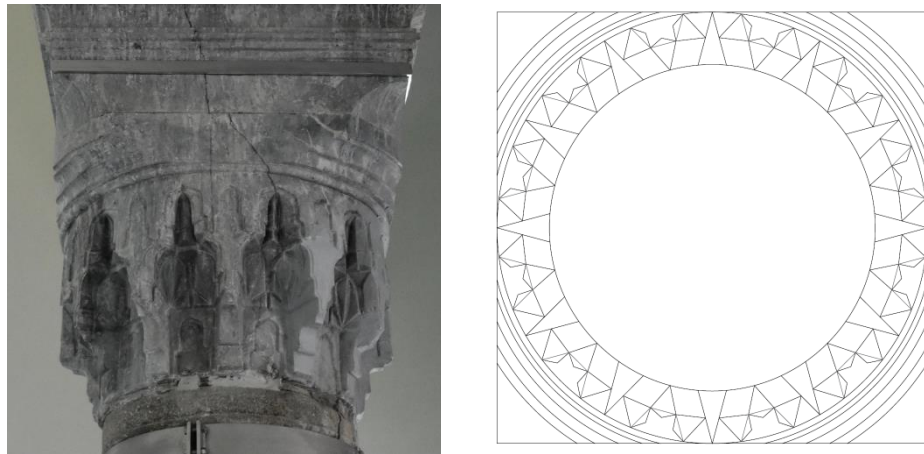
Edirne Eski Cami'nin Minare Sütuncesinin Mukarnaslı Başlığı, Solda Çizimi.
